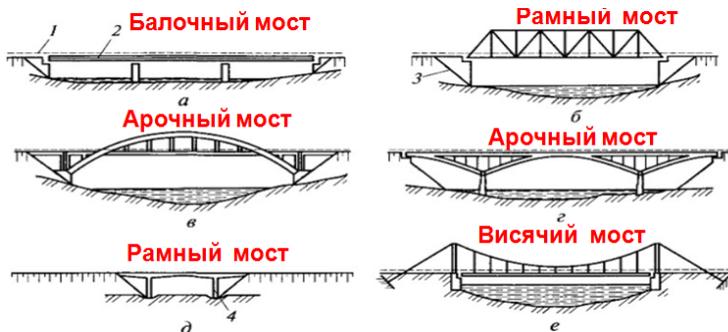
Виды мостов: а – балочный; б, д – рамный; в, г – арочный; е – висячий; 1 – береговые устои; 2 – пролетное строение; 3 – конус насыпи; 4 – быки
